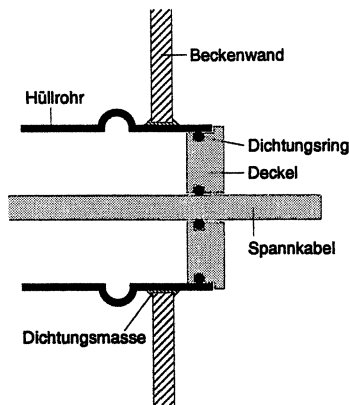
Detail Wanddurchlass Hüllrohr mit Verschlussdeckel
